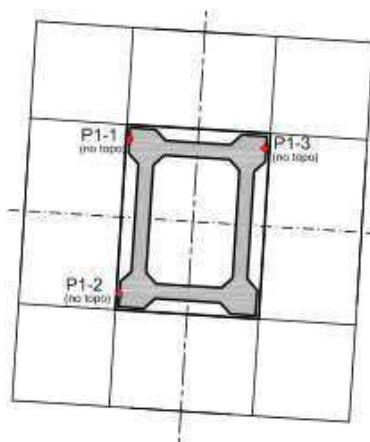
PROC – Topo dos pilares, instrumentação [12]
